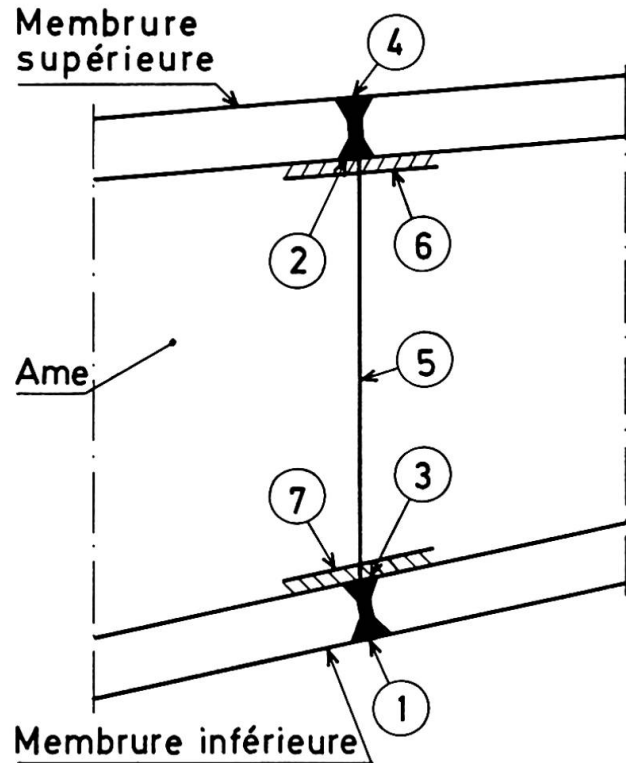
Ordre d'exécution des soudures sur chantier pour un joint de poutre en I comportant des membrures à semelle unique.
